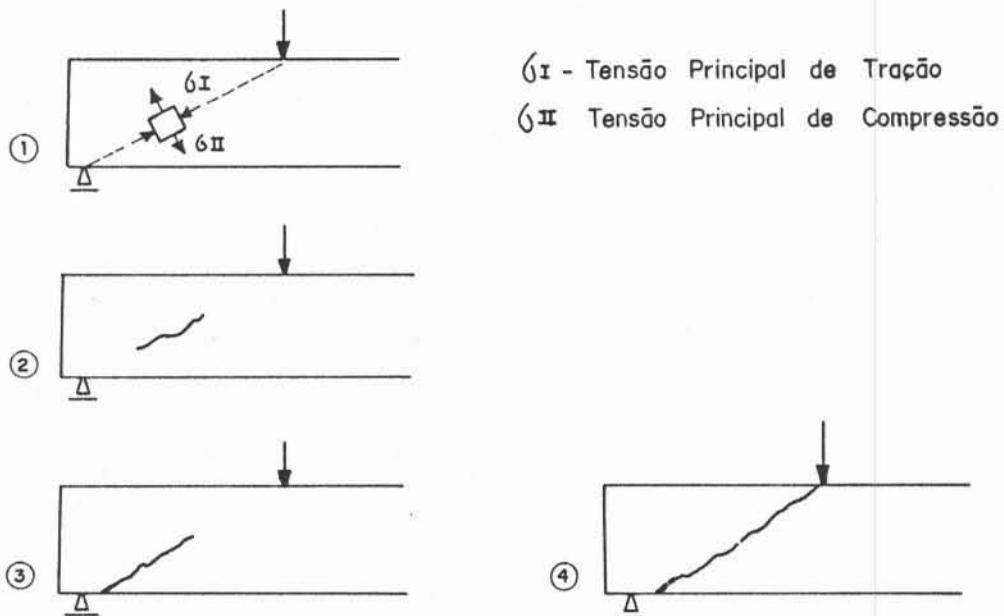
Fissura em viga provocada por esforços de cisalhamento.
